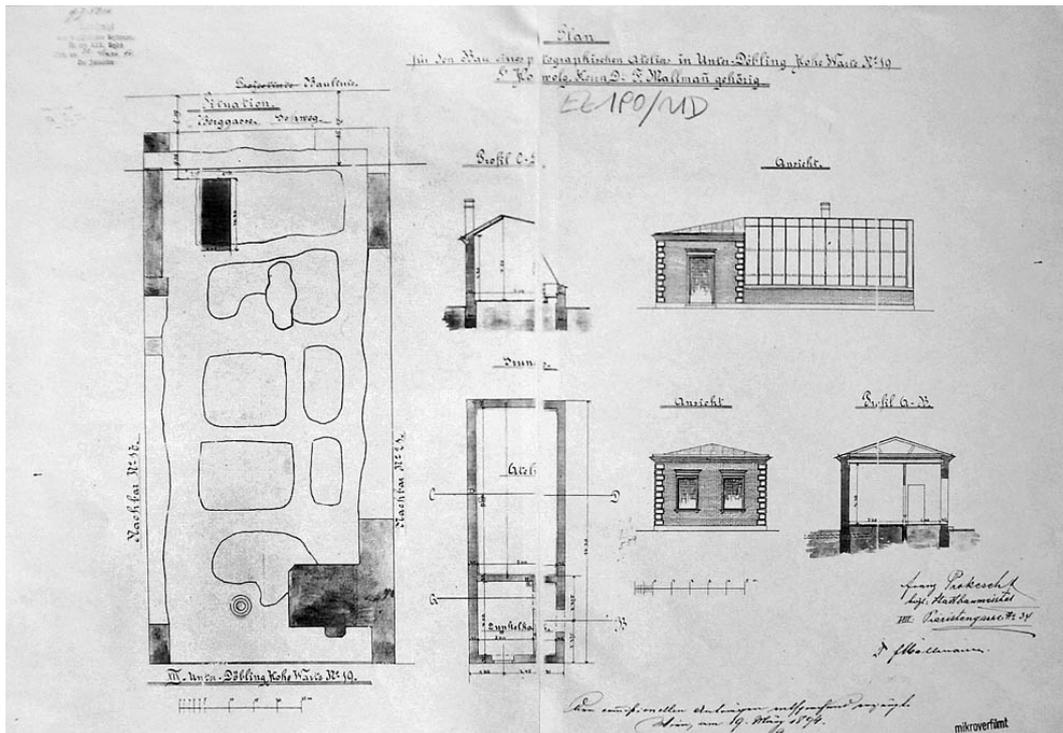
Villa Rittershausen. Plan für ein Fotoatelier im Garten. 1894. Einreichplan.
